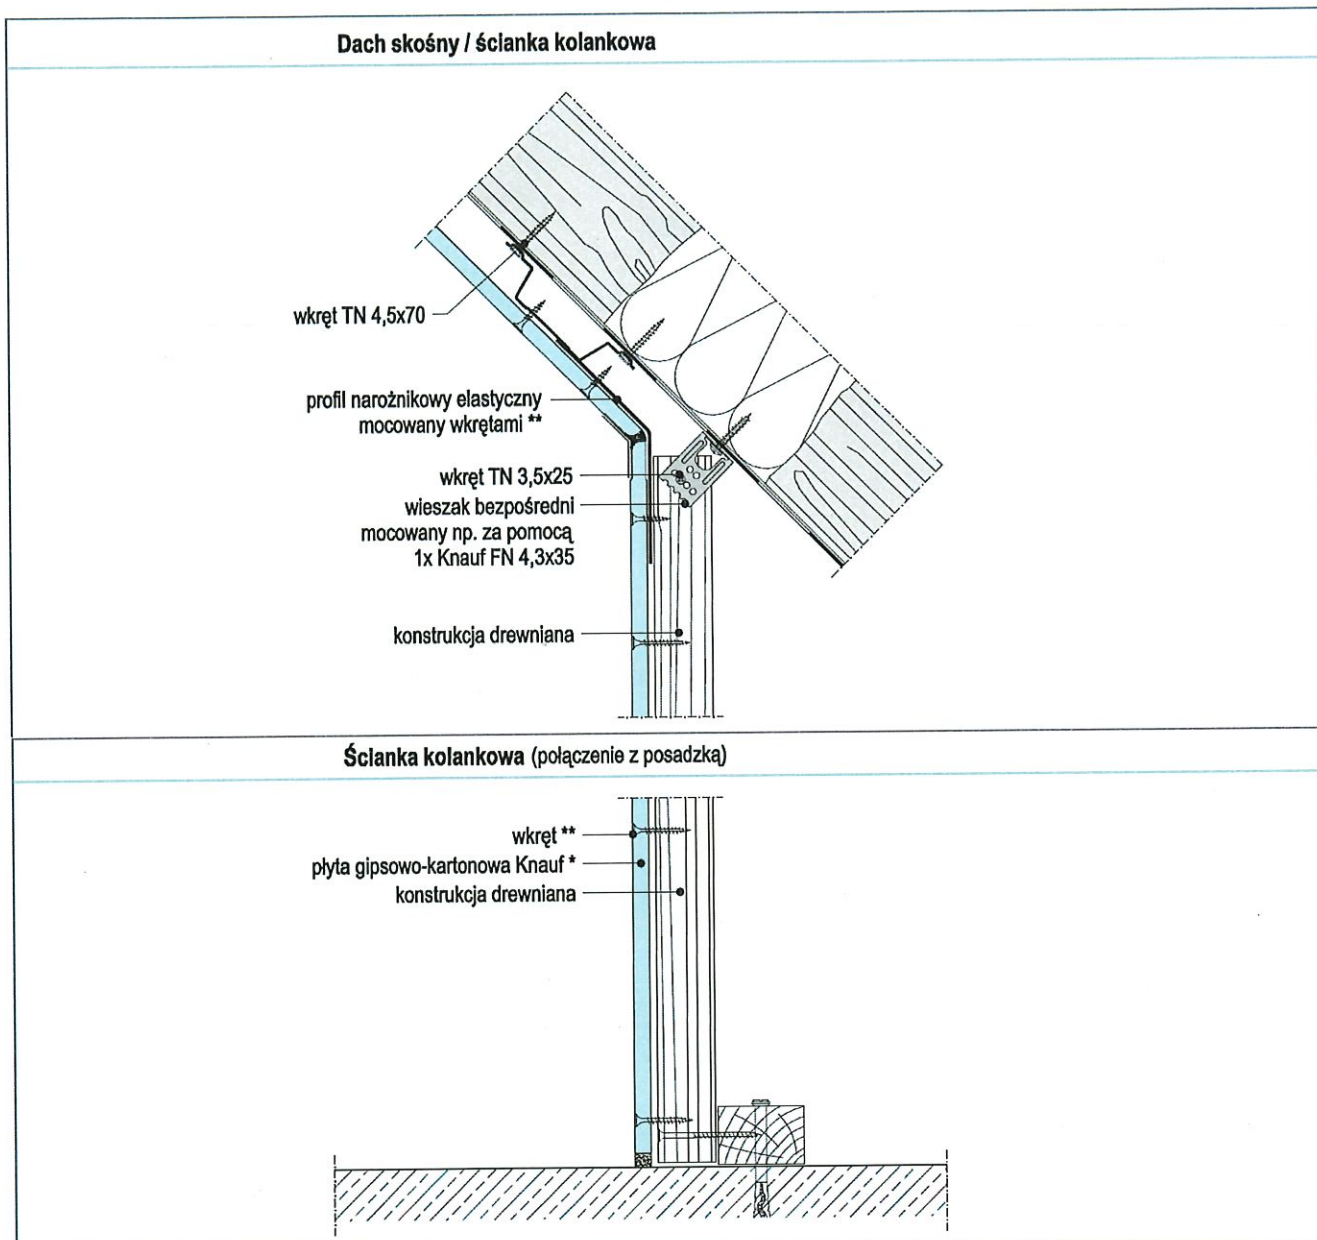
System D613.pl na konstrukcji z profilem sprężystym, przekrój pionowy dachu spadzistego.
